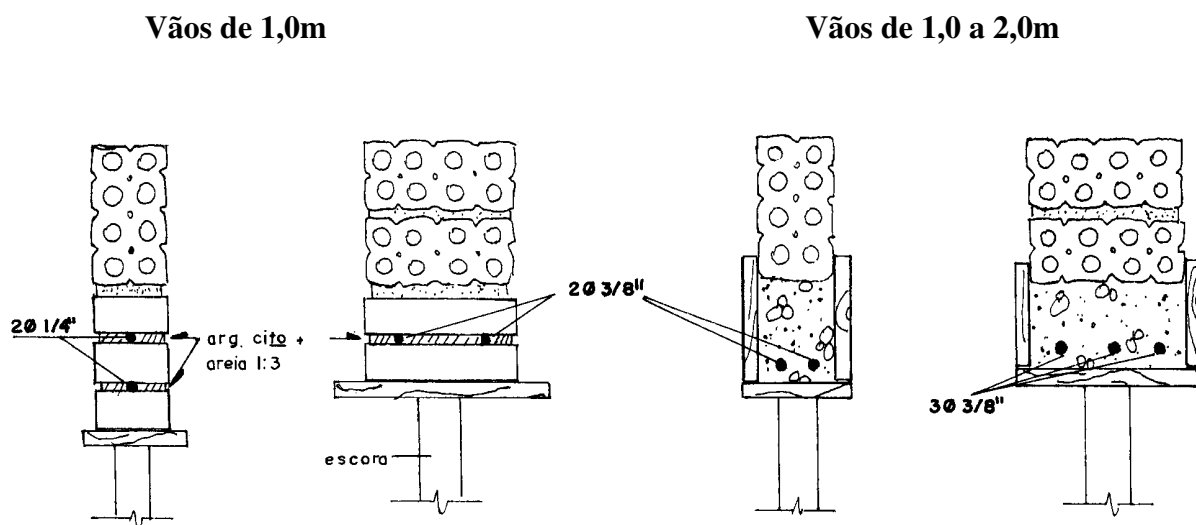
Vergas em alvenaria de tijolo furado para vãos até 1,00m e entre 1,00m e 2,00m
